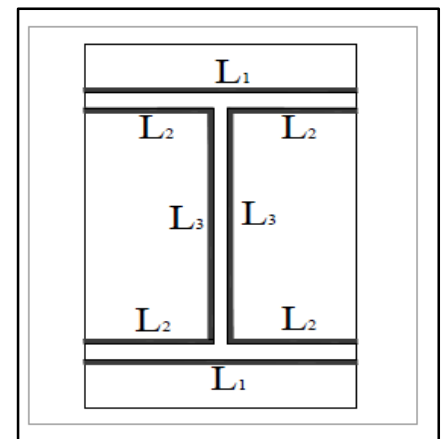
Assemblage soudé poutre-platine
